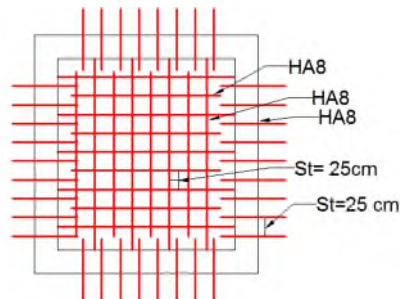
Ferrailage de la dalle au-dessous Figure.
